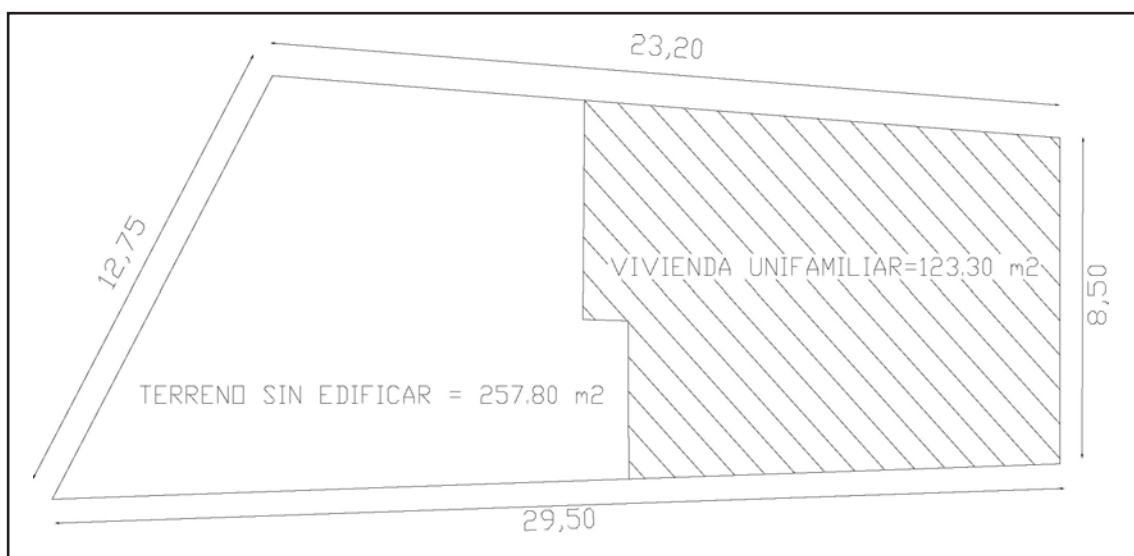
Planta del Proyecto de Construcción de una vivienda unifamiliar.
